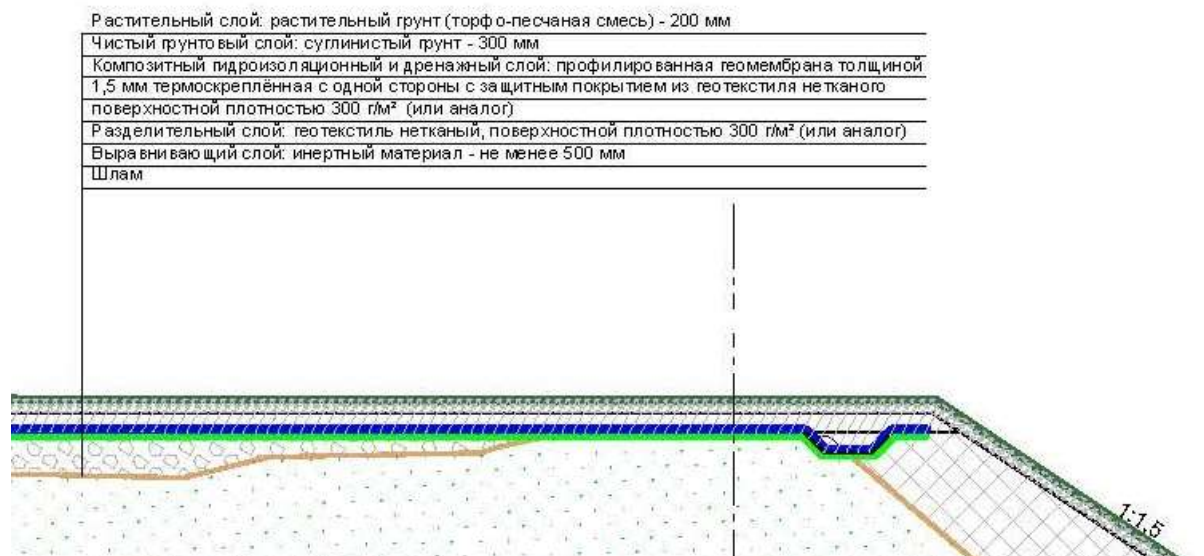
Конструкция верхнего изолирующего покрытия
